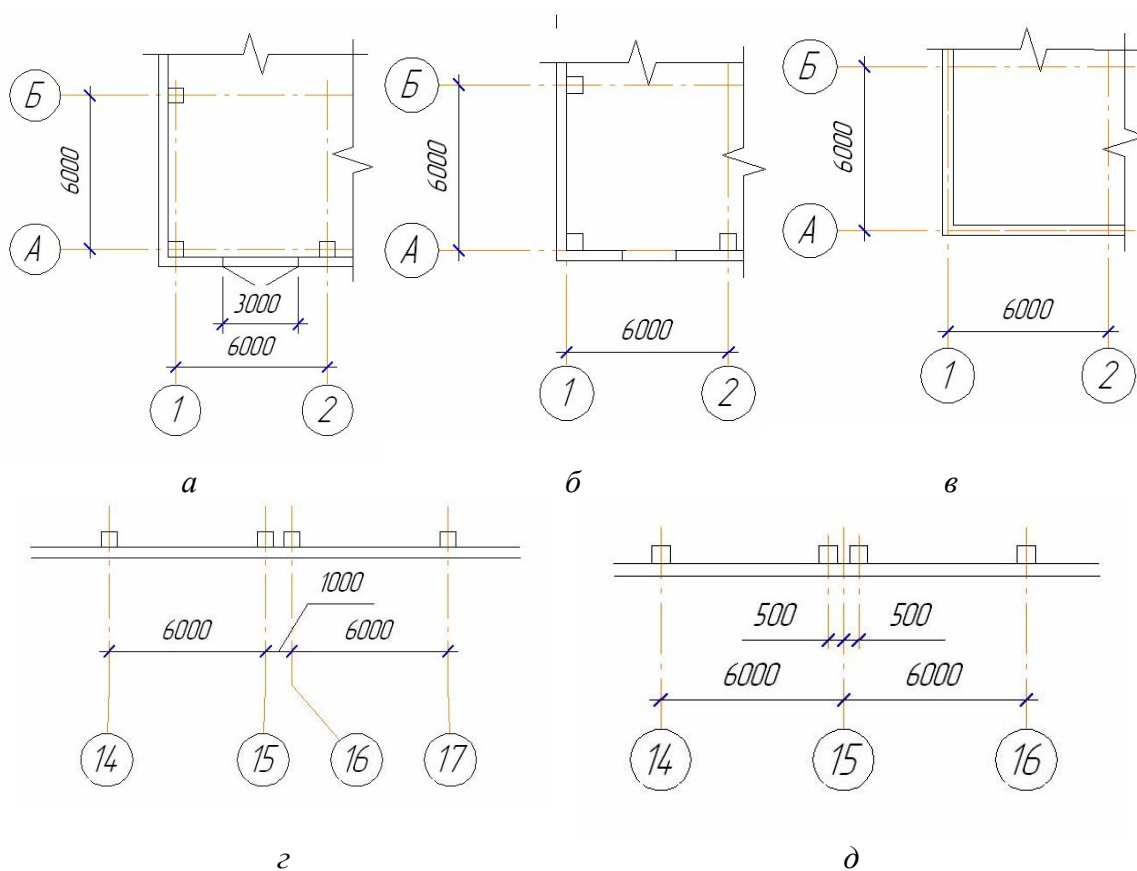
Пример привязки стен и колонн здания к разбивочным осям:
